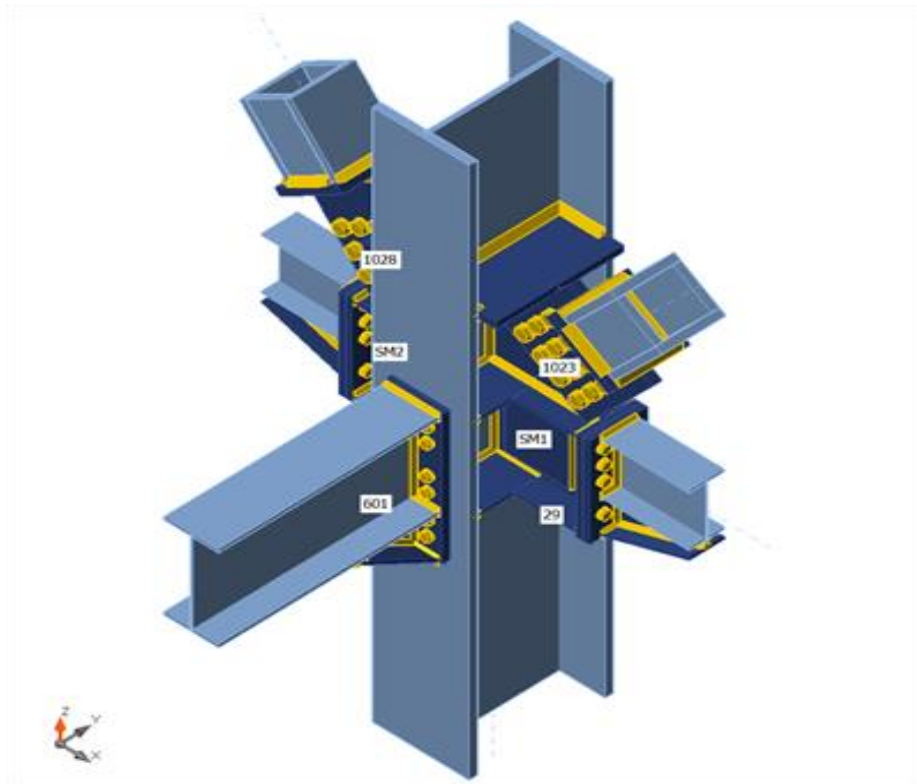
Vue d'assemblage poteau – poutre – contreventement.
